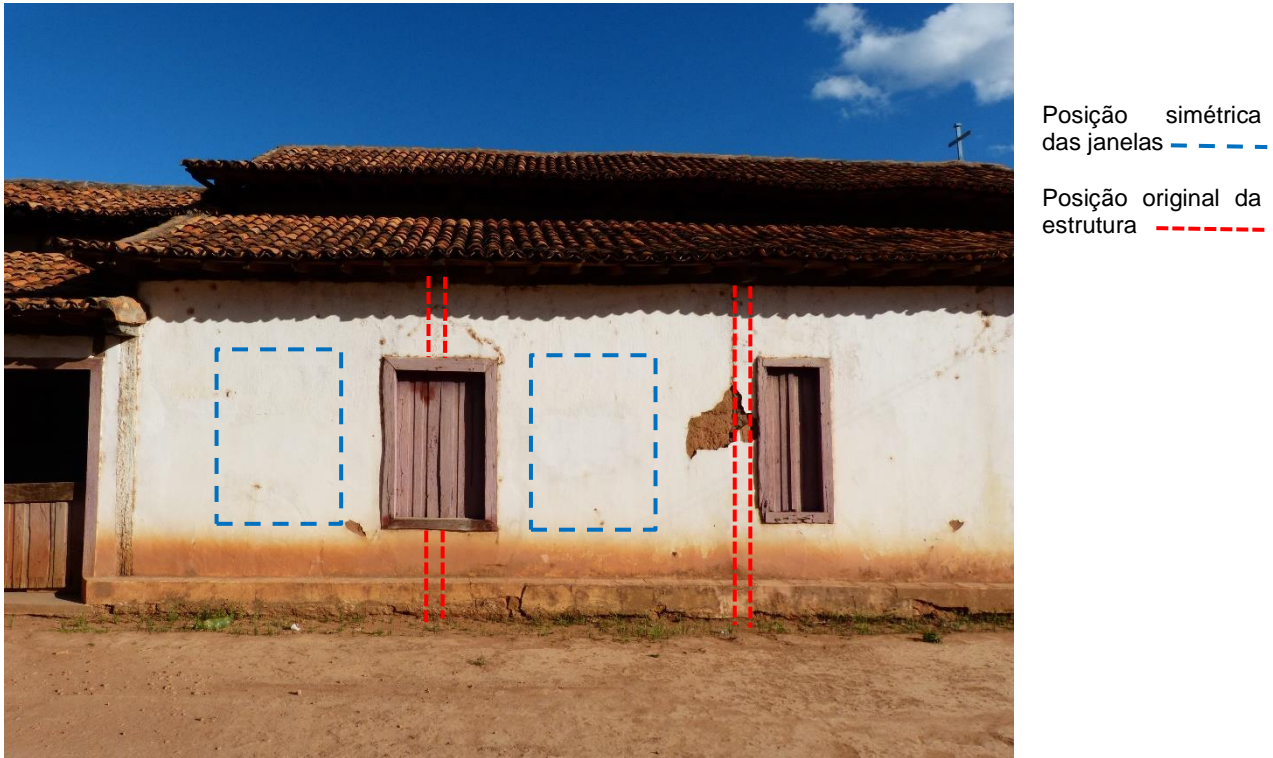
Alteração na estrutura de madeira e nas aberturas – fachada lateral esquerda.
